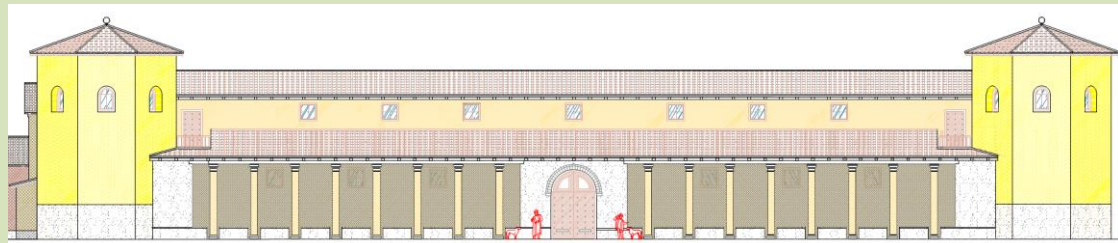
Alzado sur -I- (reconstrucción virtual). CGS.
